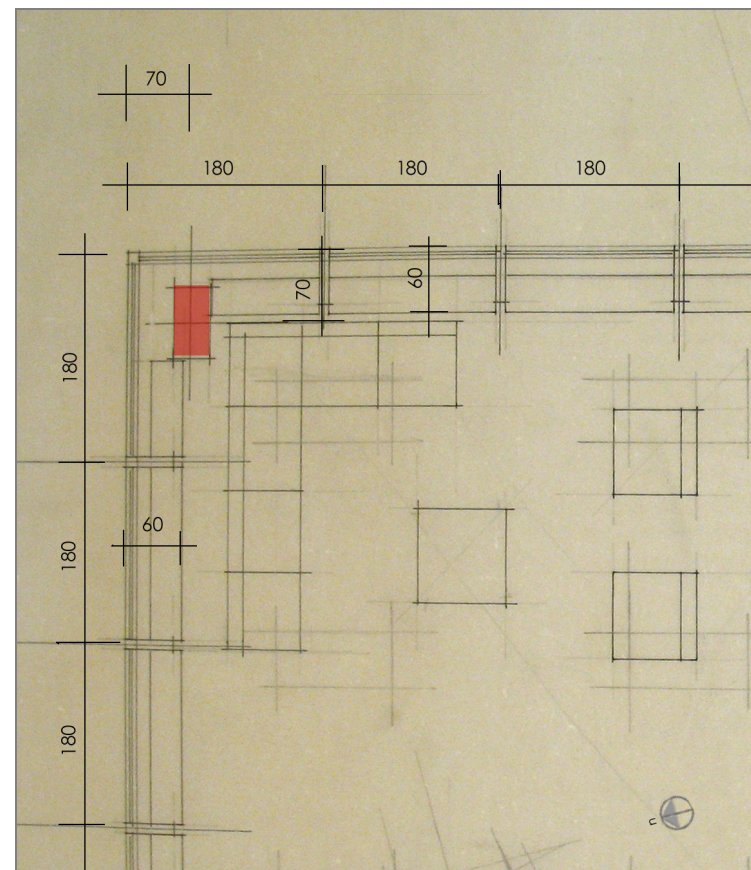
soluzione d'angolo 1961 - stralcio pianta piano 14 quotato
